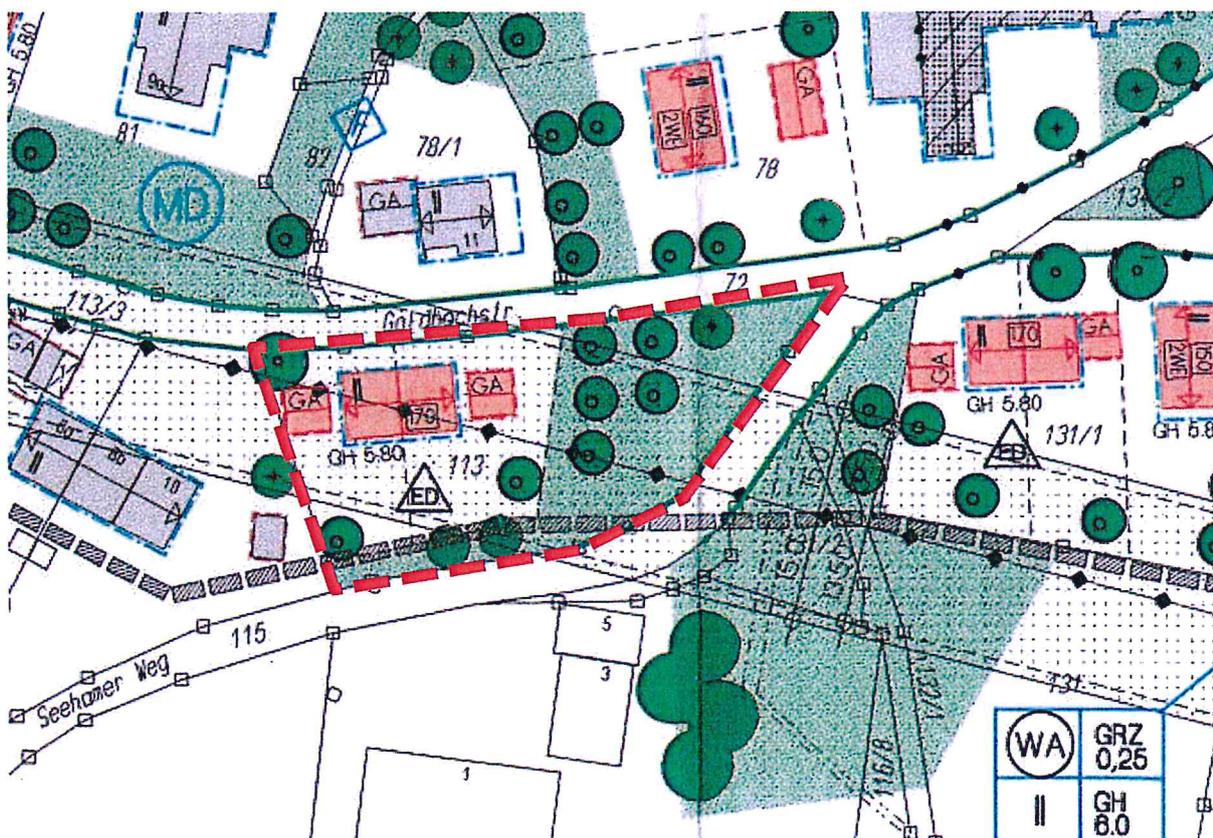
Auszug aus Bebauungsplan Nr. 80 „Fichtenstraße-Vagen“
